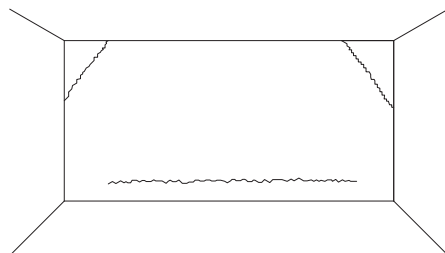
Typische Rissbildung einer Wand ohne Öffnungen.
